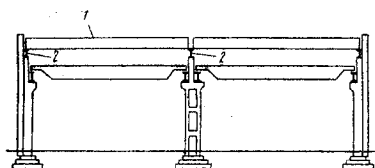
Одноэтажные промышленные здания с плоским покрытием
